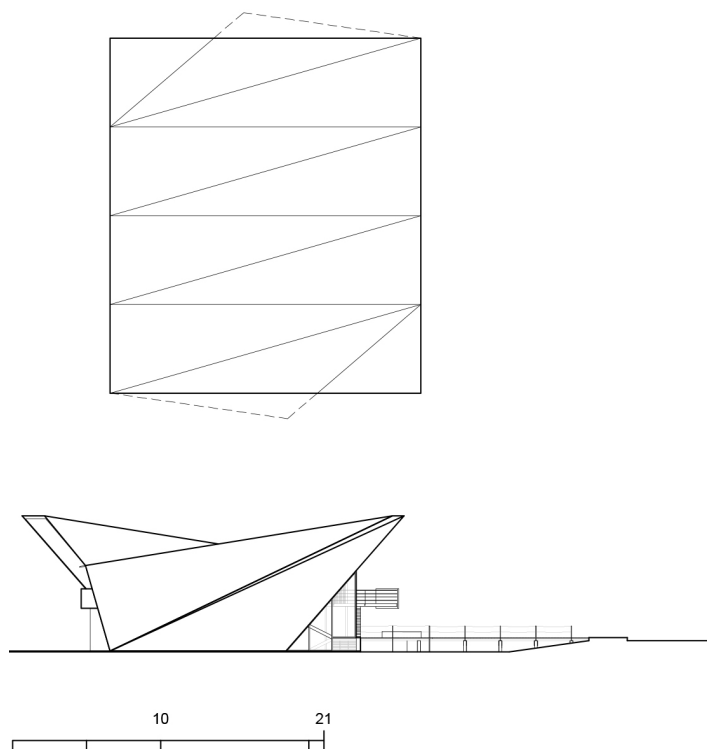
Cubierta desplegada de 21 x 24 m (en línea punteada los suplementos estructurales) y alzado este (fuente: El autor).
